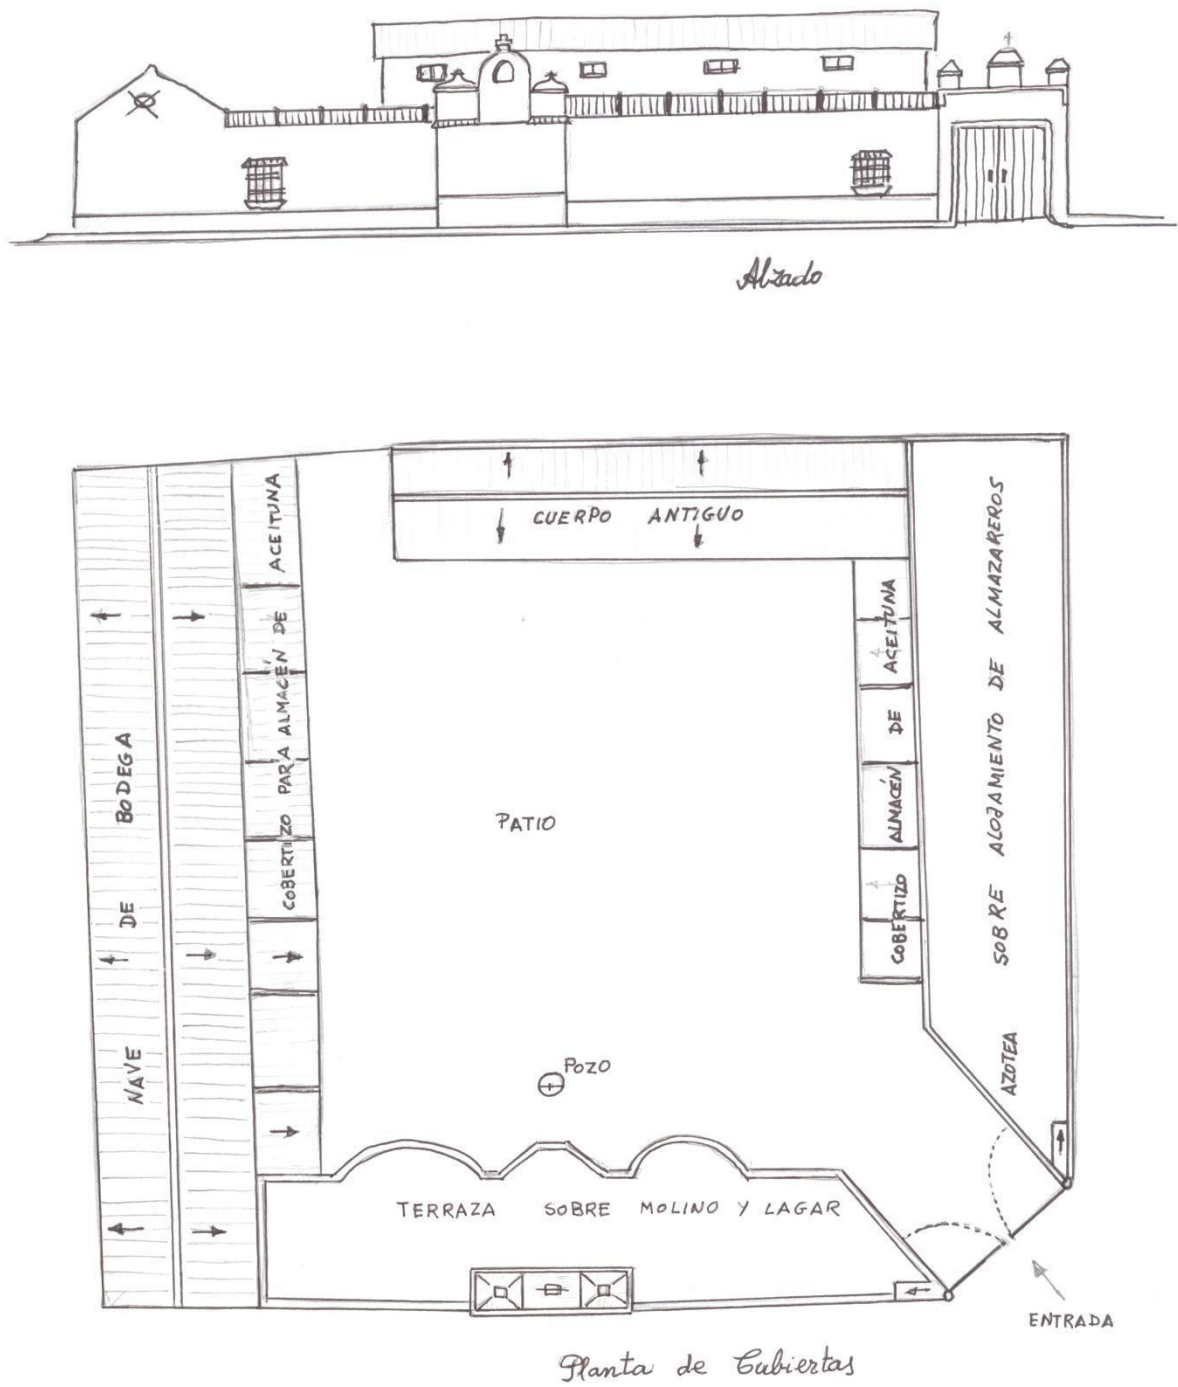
Planos de planta de cubiertas, alzado del molino y dependencias anejas de la citada hacienda.
